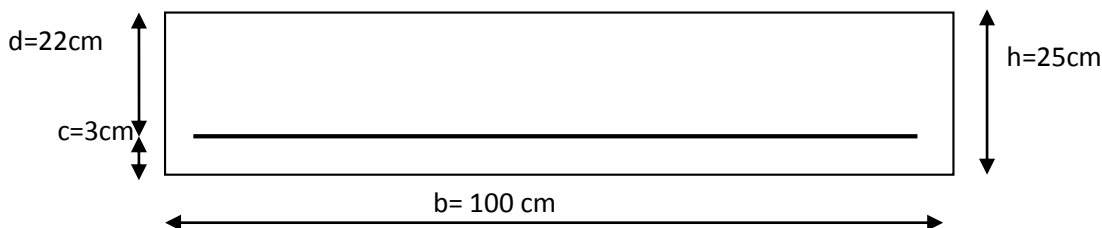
Schéma statique du ferrailage de voiles périphérique
